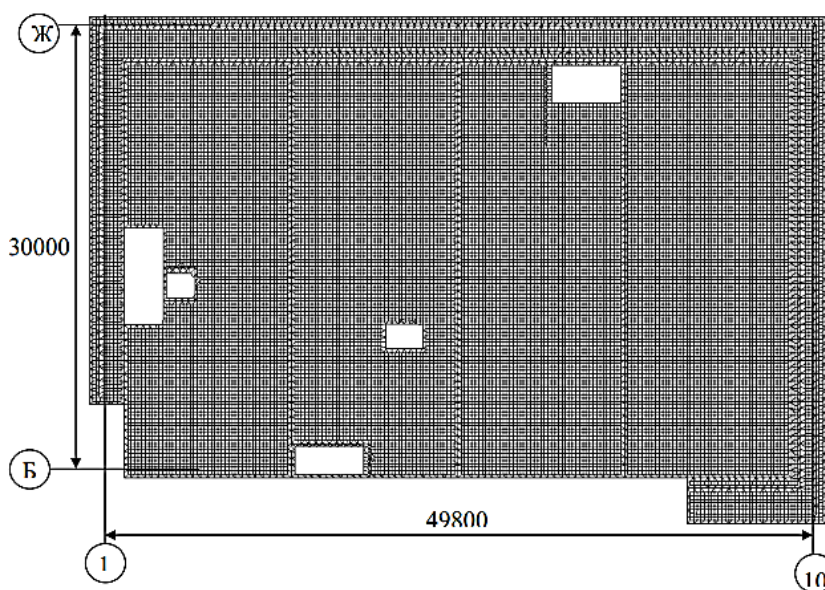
Розрахункова схема плити перекриття на позначці +4,420
